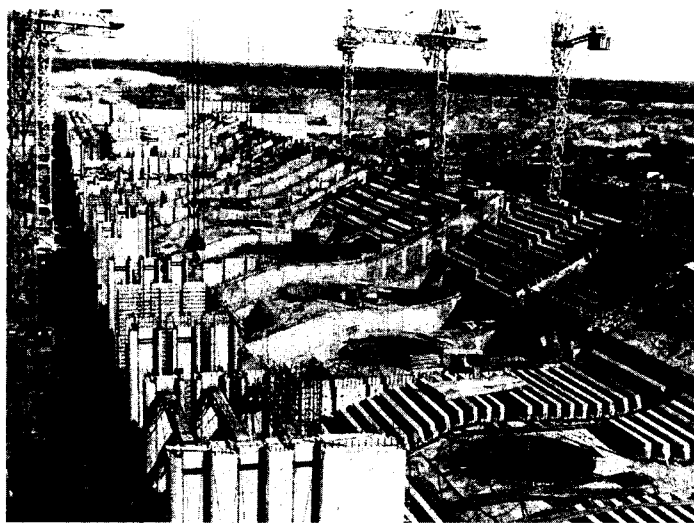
Перекрытие отсасывающих труб и глубинных водосборов гидроэлектростанции сборными железобетонными балками на Чебоксарской ГЭС
